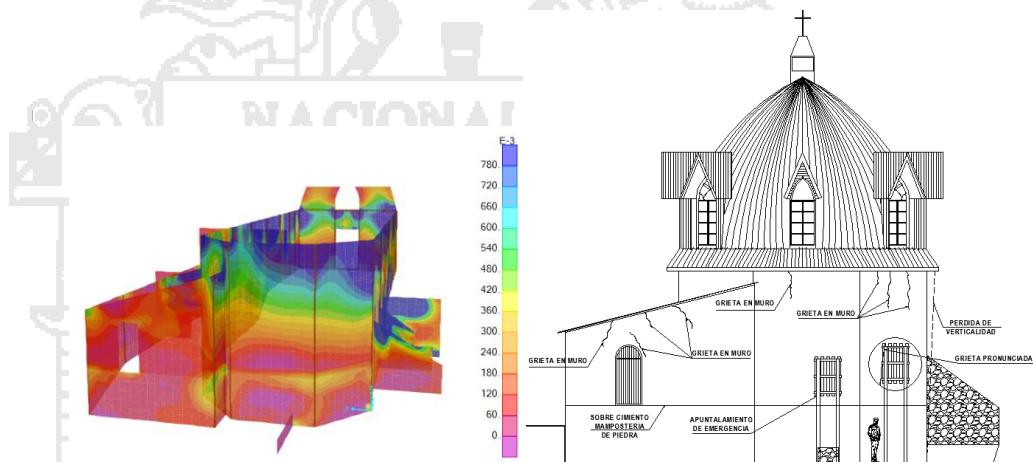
Grietas formadas a causa de esfuerzos a flexión en muro posterior.
